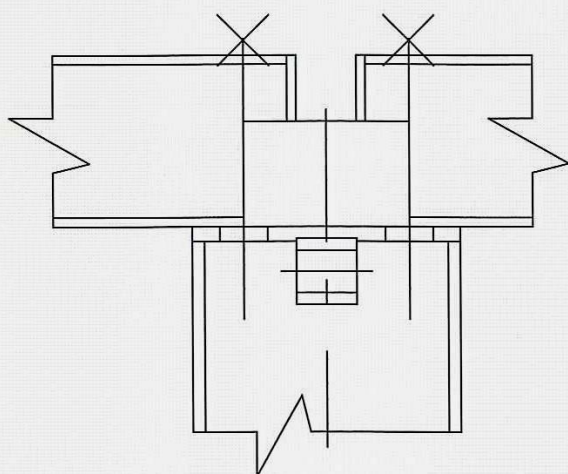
## DETAILY HORNÍHO PRŮBĚŽNÉHO ZTUŽENÍ
